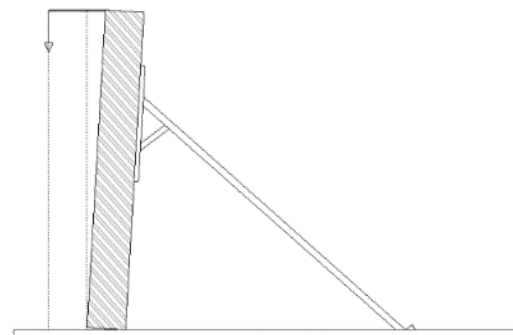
Enderezado de muro de adobe. Fuente: Elaboración propia.
